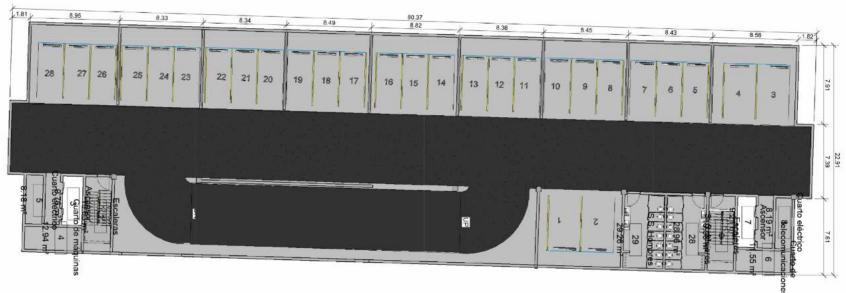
Planta primer nivel subterráneo para propuesta arquitectónica de parqueo subterráneo.
